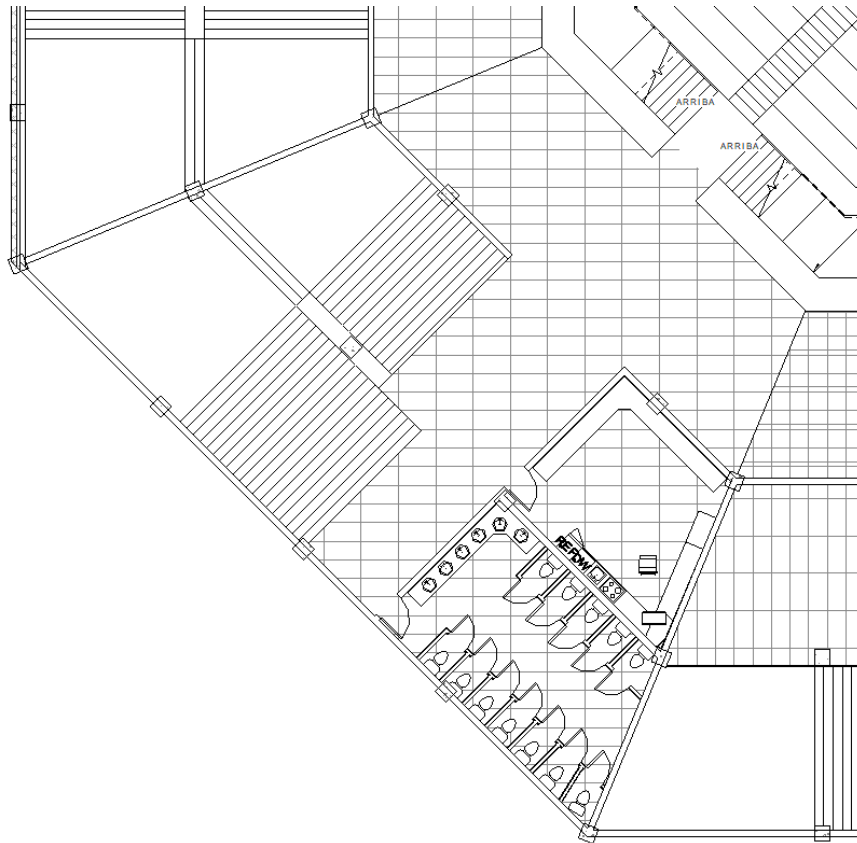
Vista en planta del codo sudoeste. Fuente: elaboración propia.
